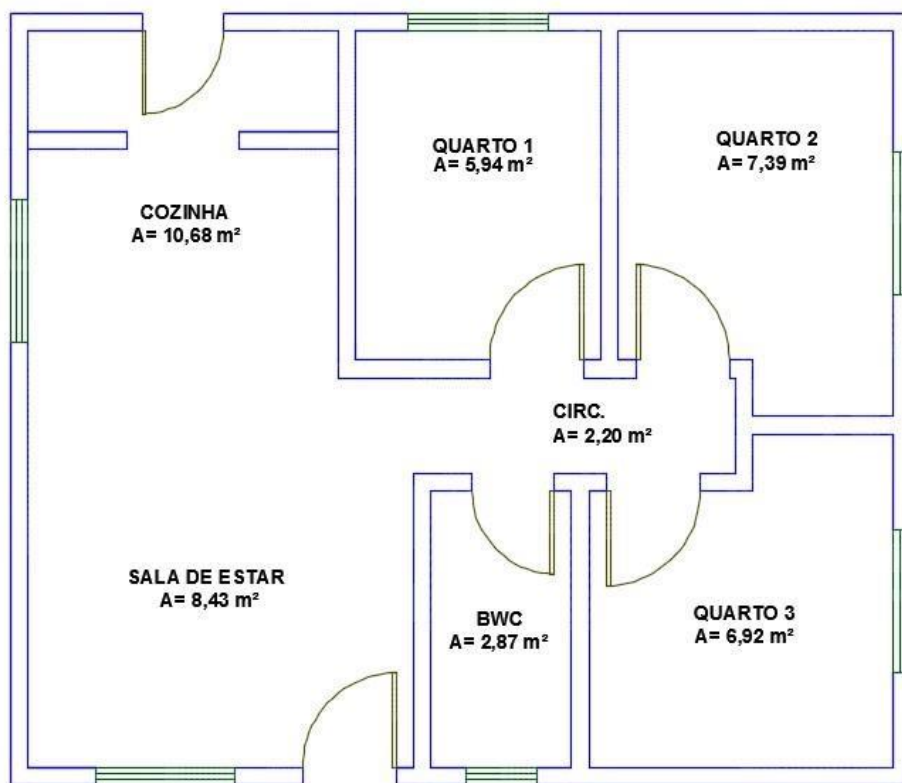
Layout da planta baixa. Fonte: ECKER E MARTINS (2014).
